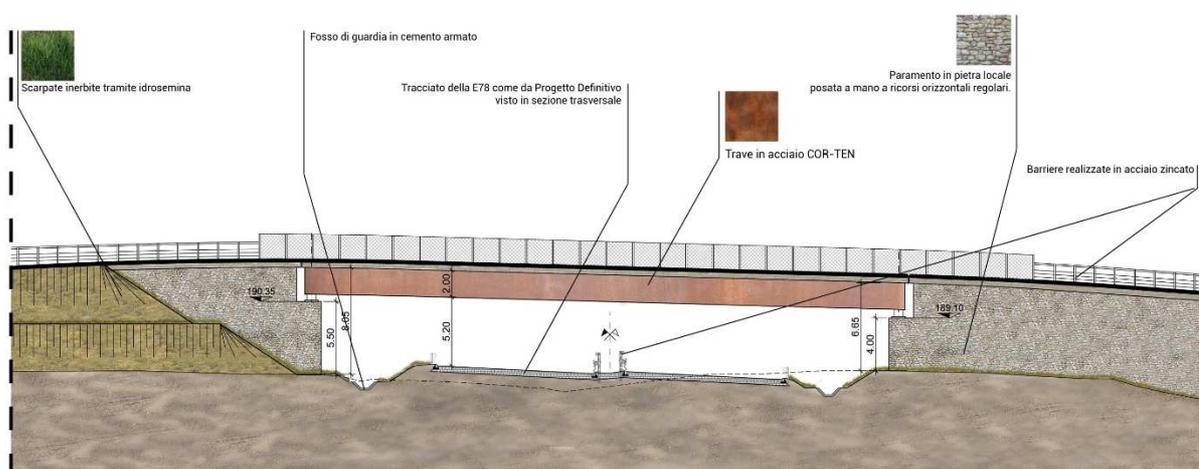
Prospetto del Cavalcavia Agricolo Merse, le cui spalle verranno trattate con rivestimento lapideo.
